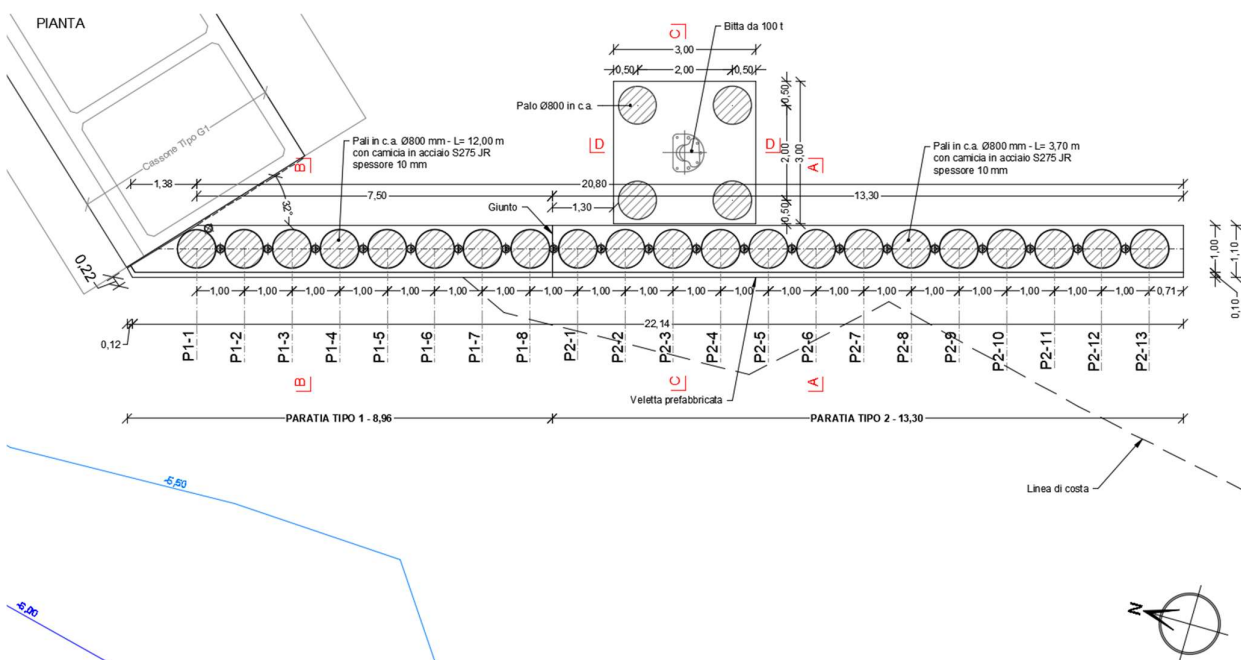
Paratia Tipo 1 e Tipo 2: planimetria
